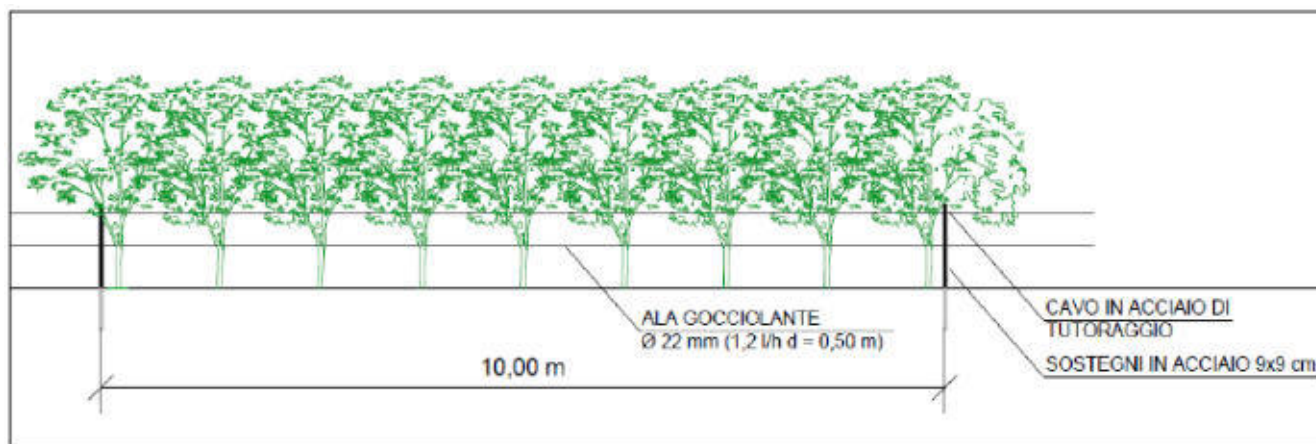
Sistema d'irrigazione e sistemi di tutoraggio
